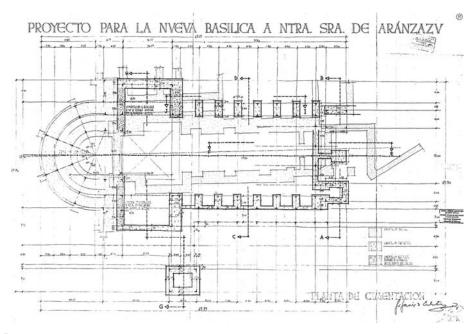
Plano nº 31 del Proyecto de ejecución: Planta de Cimentación. (Archivo del Santuario de Arantzazu)
